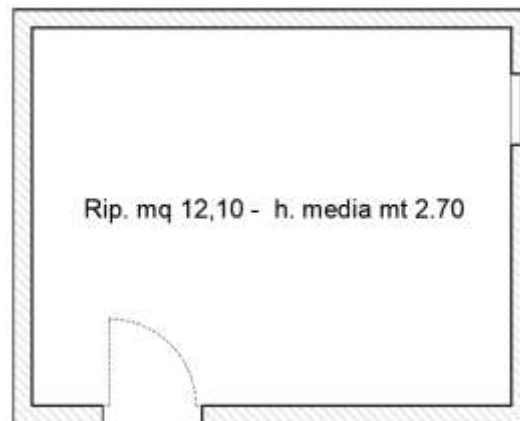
planimetria del ripostiglio ricavato nella particella 489
